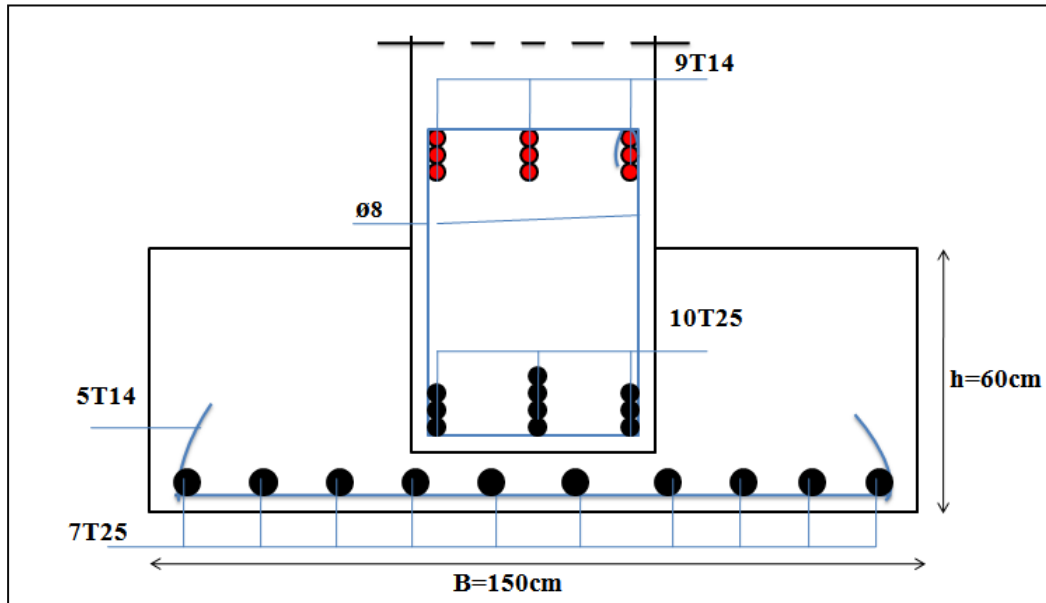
Ferrailage de semelle continue sous murs voiles
